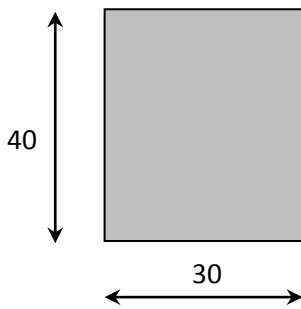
Dimensions de la poutre principale Figure II.5). : Dimension de la poutre secondaire
